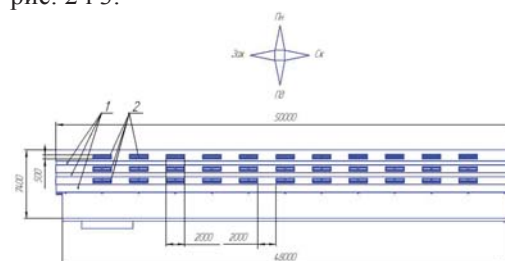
Фасад тваринницької будівлі на 20 корів з поголів'ям молодняку: 1 – полікарбонат прозорий; 2 – клапани вентиляційні
